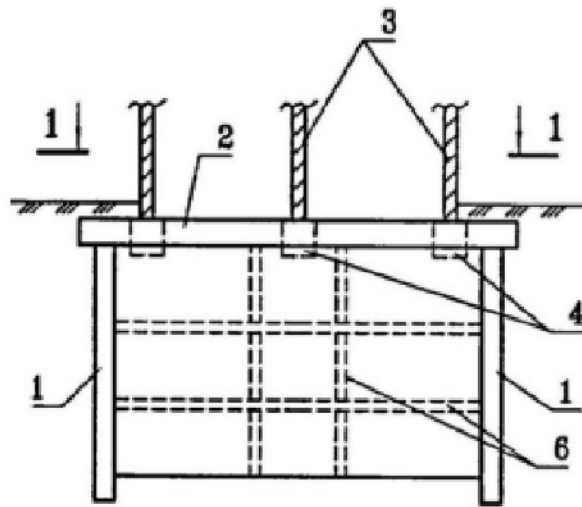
Схема влаштування підземного поверху: 1 - стіни підземної споруди; 2 - залізобетонна несуча плита; 3 - несучі стіни будівлі; 4 - фундаменти; 6 - конструкції підземних поверхів
